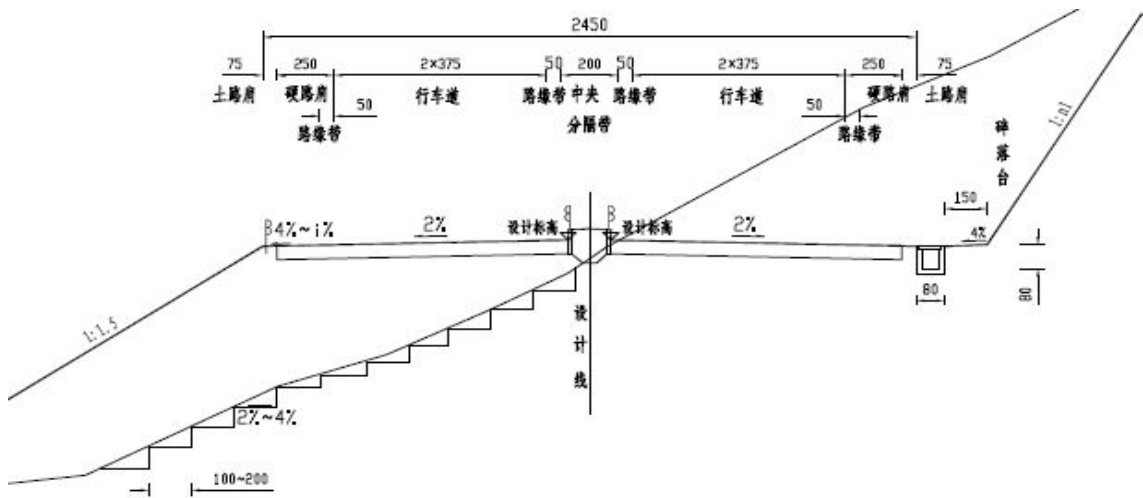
路基横断面图 (K4+070~K12+370) (单位: cm)
